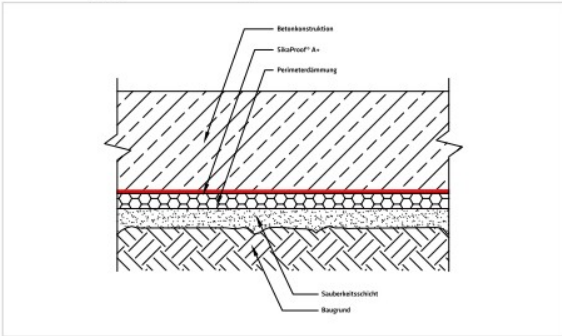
Verlegung auf Sauberkeitsschicht
